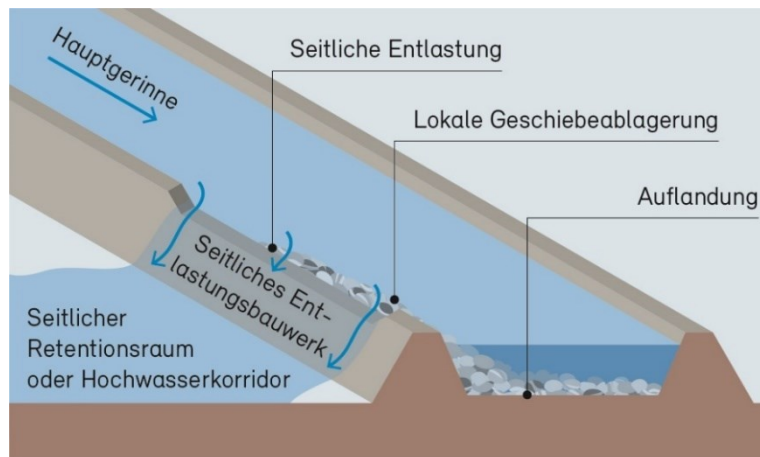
Seitliches Entlastungsbauwerk mit lokaler Geschiebeablagerung und Auflandung flussabwärts. Quelle: BAFU, 2023
